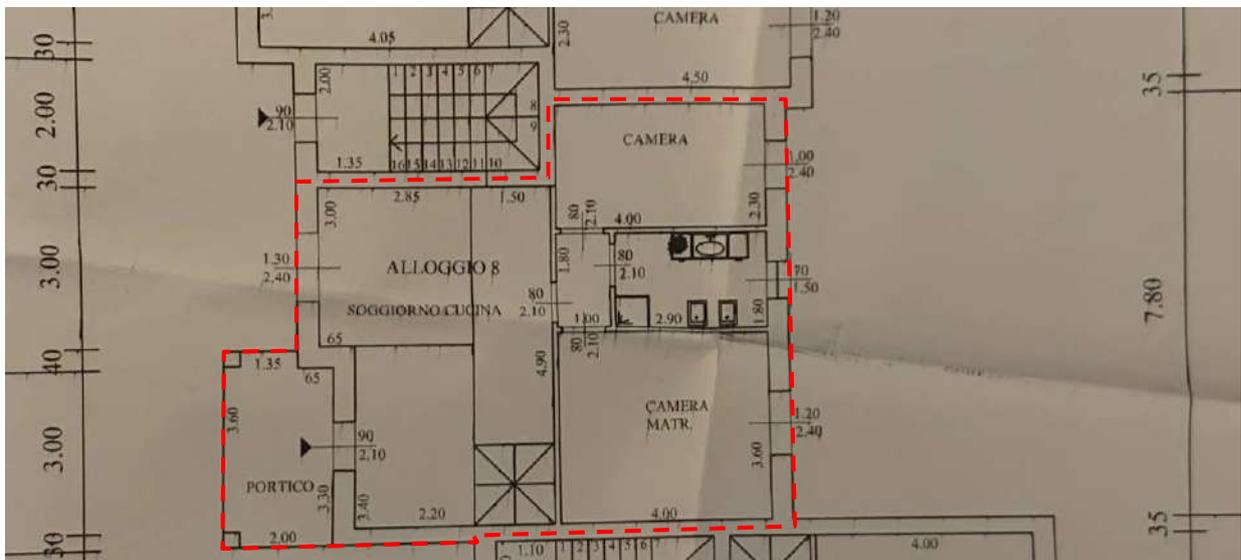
D.I.A. n. 05 Prot. 1315 del 09.02.2005 – Estratto tav. 4 pianta piano terra Blocco "B" con indicazione dell'immobile in oggetto
